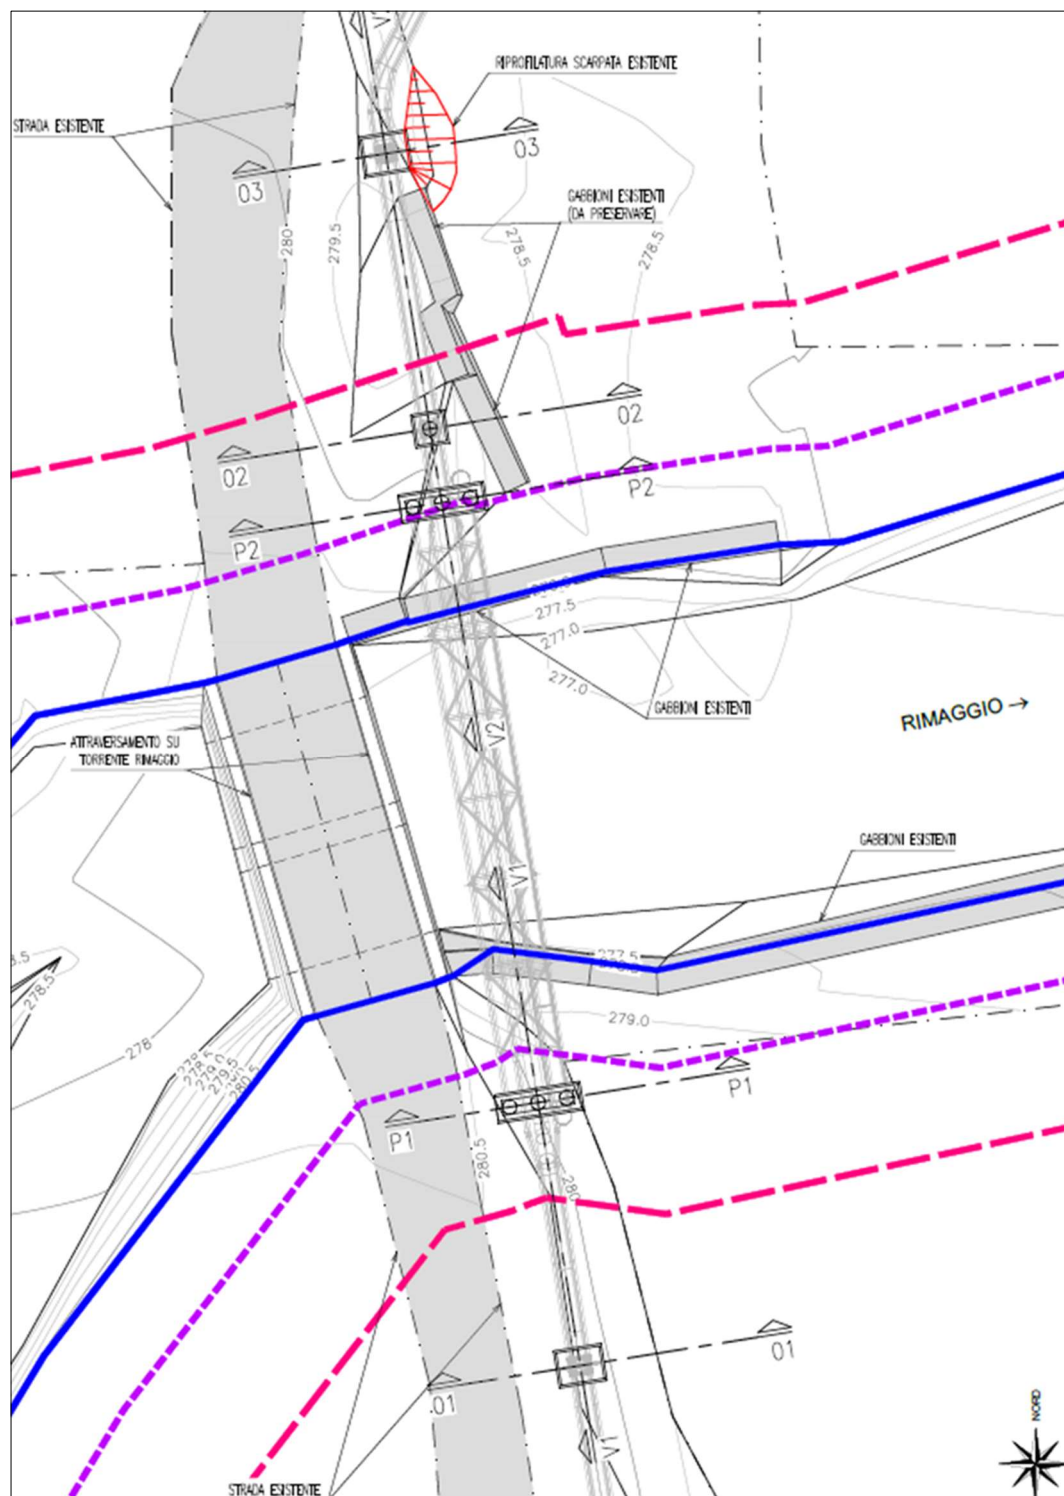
Stralcio planimetrico fase di rinterri e ripristini
